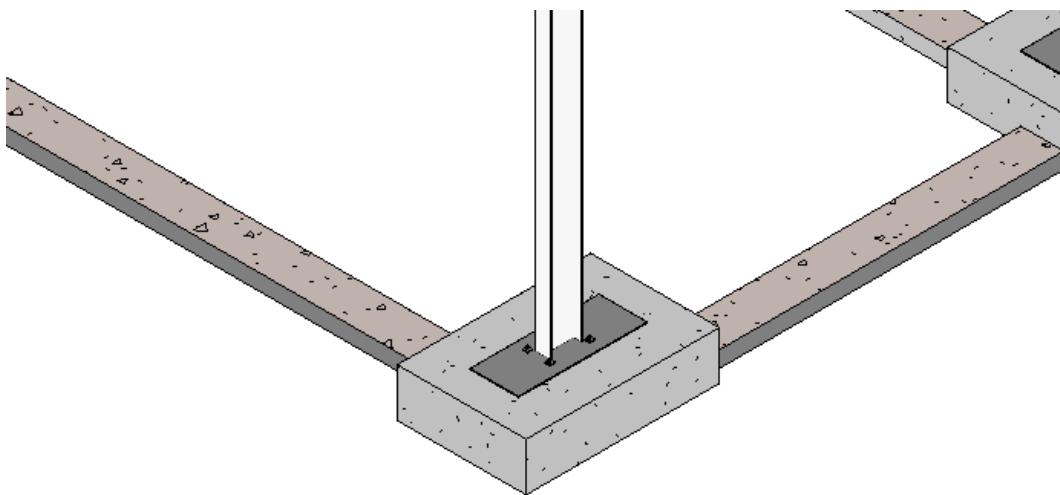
Detalle constructivo zapata - viga de atado - pilar - unión. [Elaboración propia]
